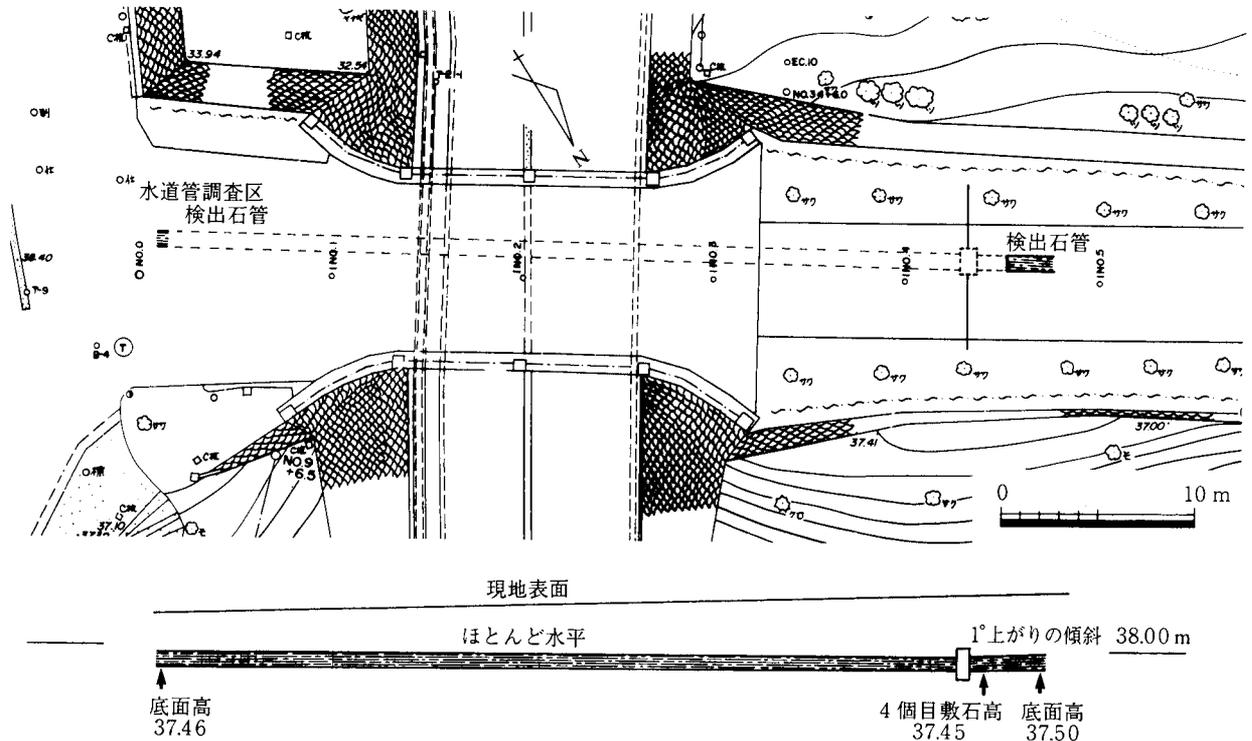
辰巳用水石管設置推定位置図 (平面図1/400、断面図高低1/200)
